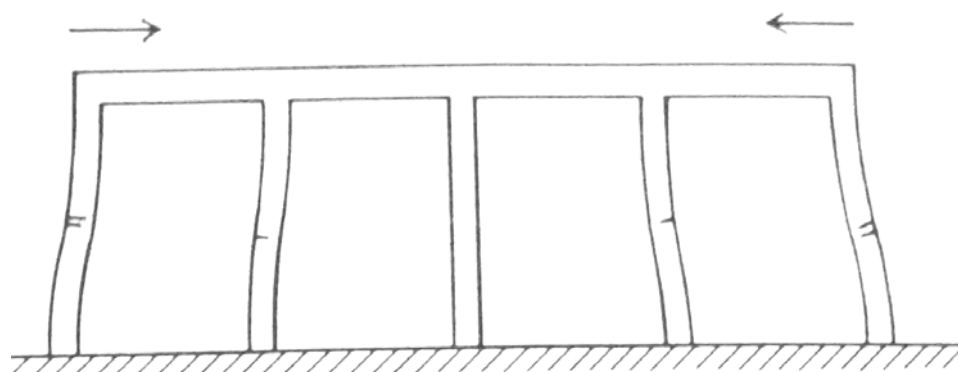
Fissuras horizontais nos pilares, devidas à retração do concreto das vigas superiores
